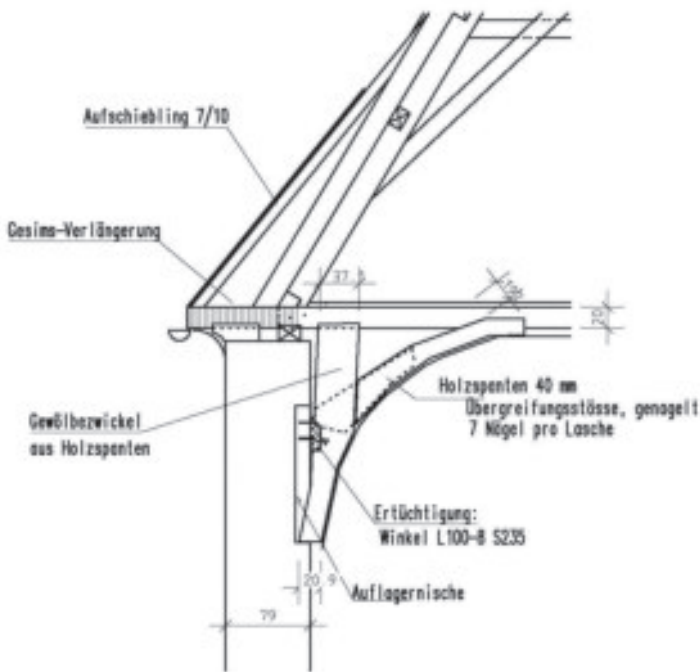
St. Ulrich, Eresing, Traufdetail, Sprengwerksauflager, Gesimsverbreiterung, Zwickelgewölbe aus Holzspanten, Planzeichnungen IB Bader, Windach
